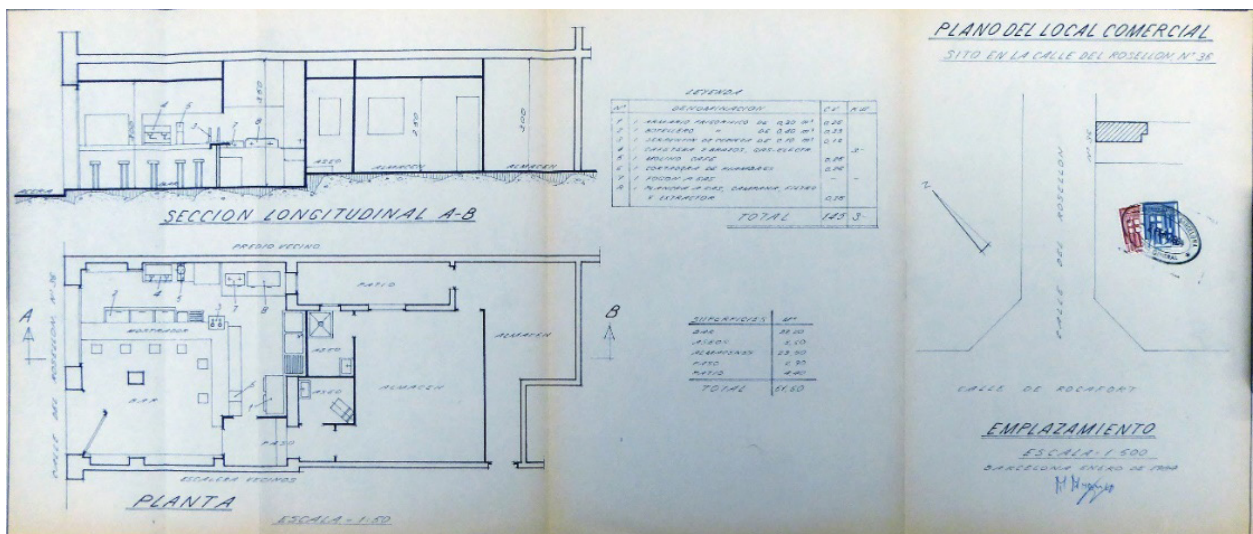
Plano de la reforma realizada en planta baja. Expediente 340286/1984 "Licencia de Actividad" Arxiu Municipal Contemporaneo de Barcelona.
